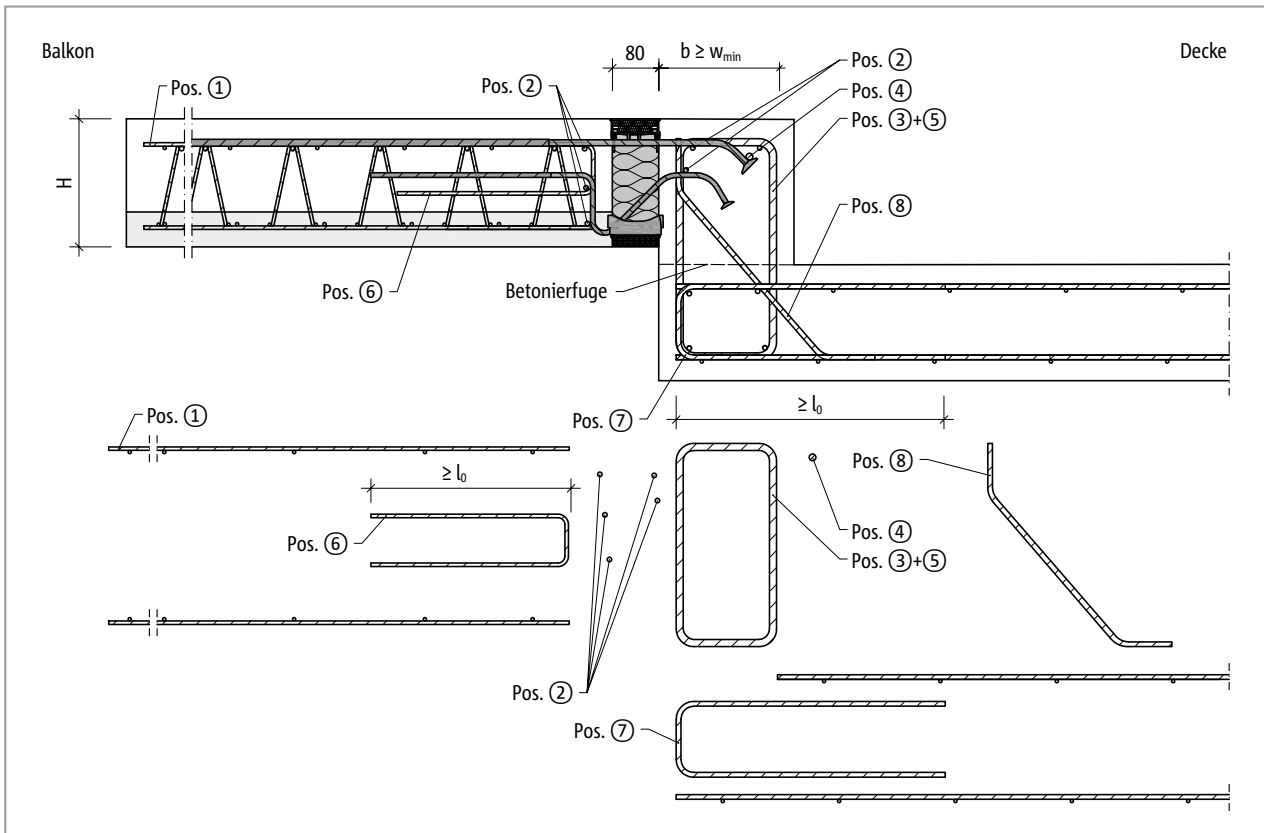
Schöck Isokorb® T Typ K-O-F: Bauseitige Bewehrung für Balkon mit Höhenversatz nach oben
